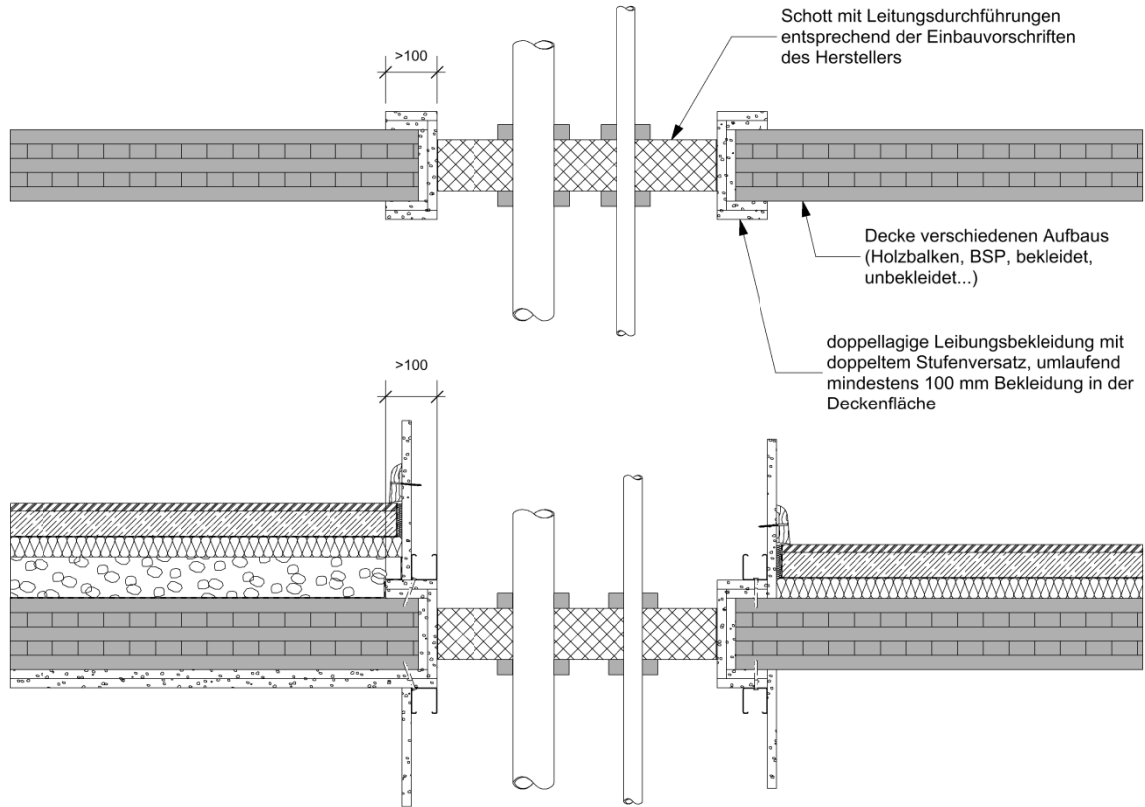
Einbau von Abschottungen entsprechend der Empfehlungen des „Fire in Timber“ Projektes. Vorgeschlagen wird eine doppellagige Leibungsbekleidung mit doppeltem Stufenversatz. Oben Prinzipdarstellung, unten Umsetzung für praxisübliche Deckenaufbauten aus Brettsperholz
